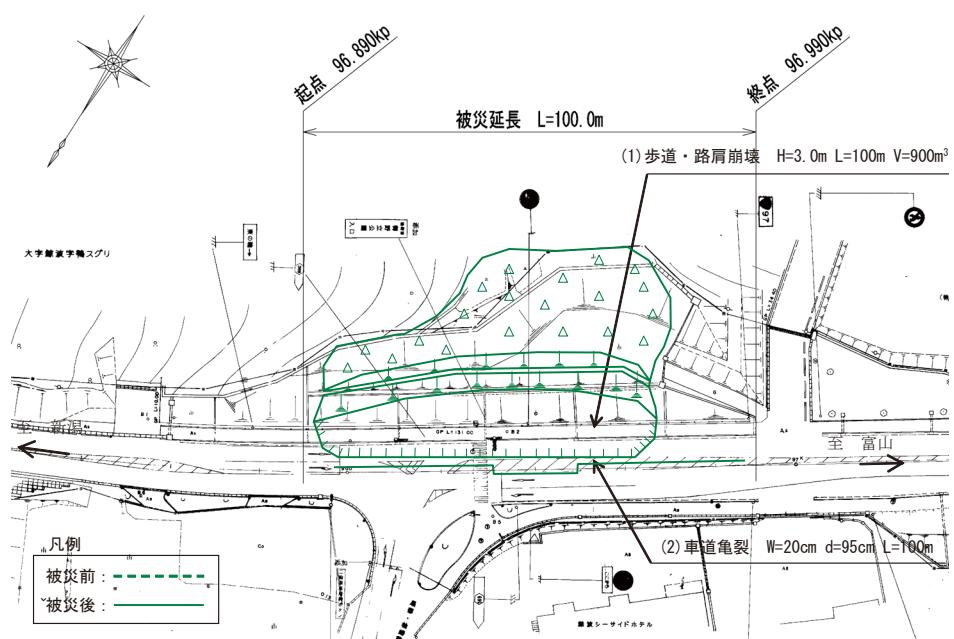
被災箇所平面図（国道8号 柏崎市鯨波地先）
